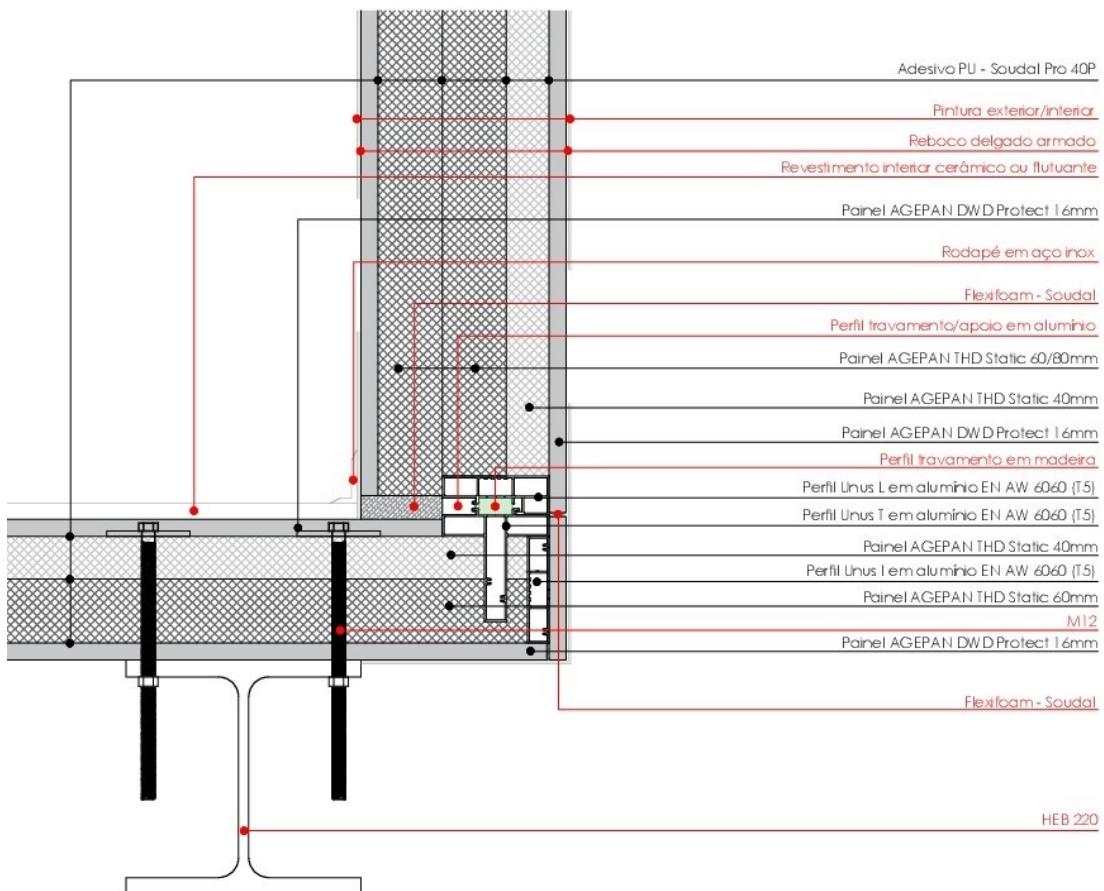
Solução AGEPLAN – Pormenor Construtivo de Pisos/ Paredes III.
